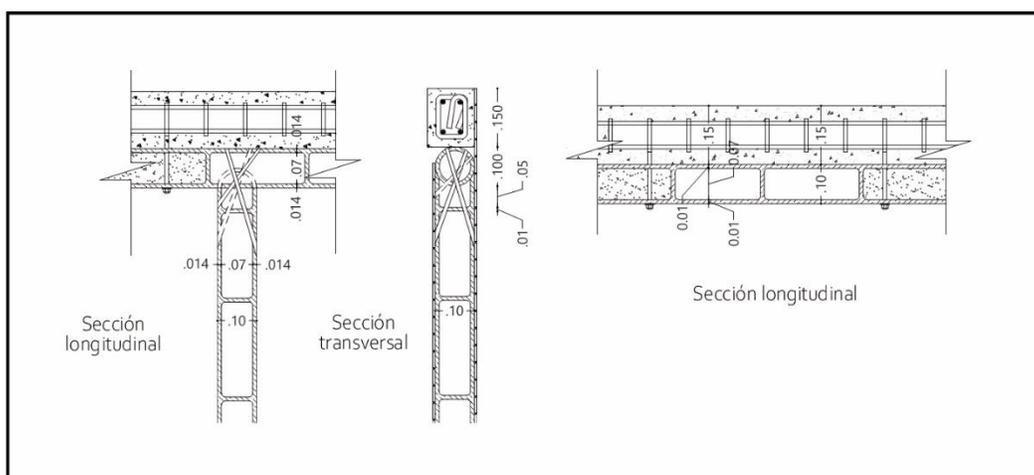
Unión superior con pasadores entre culmos y Sistema de anclaje entre viga de amarre y la guadua
